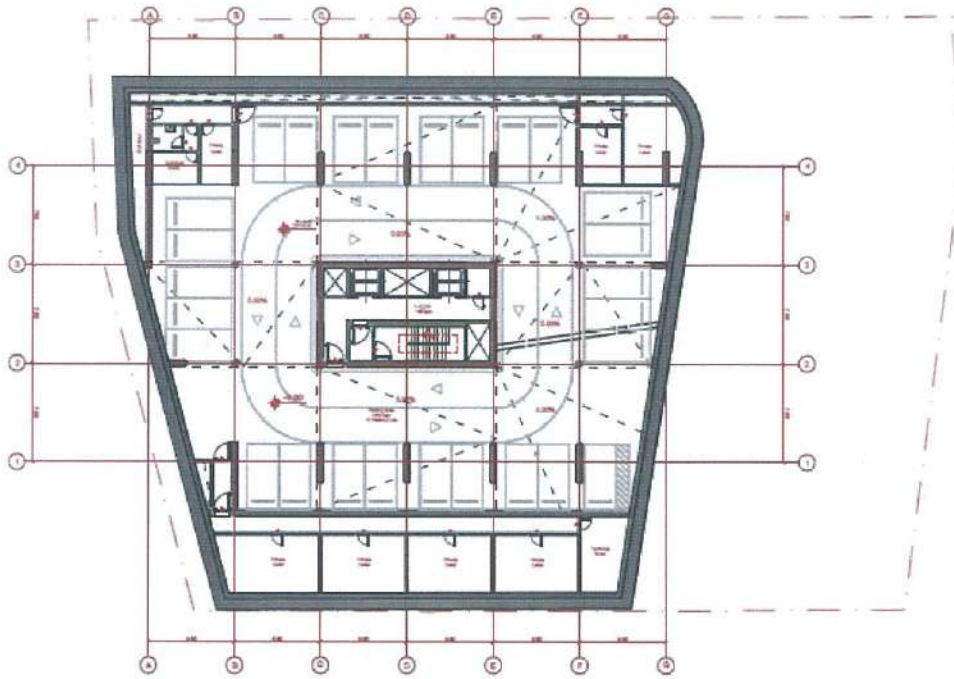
Planimetria e katit -2, në kuotën -7.22 SIP 1 515 m²
